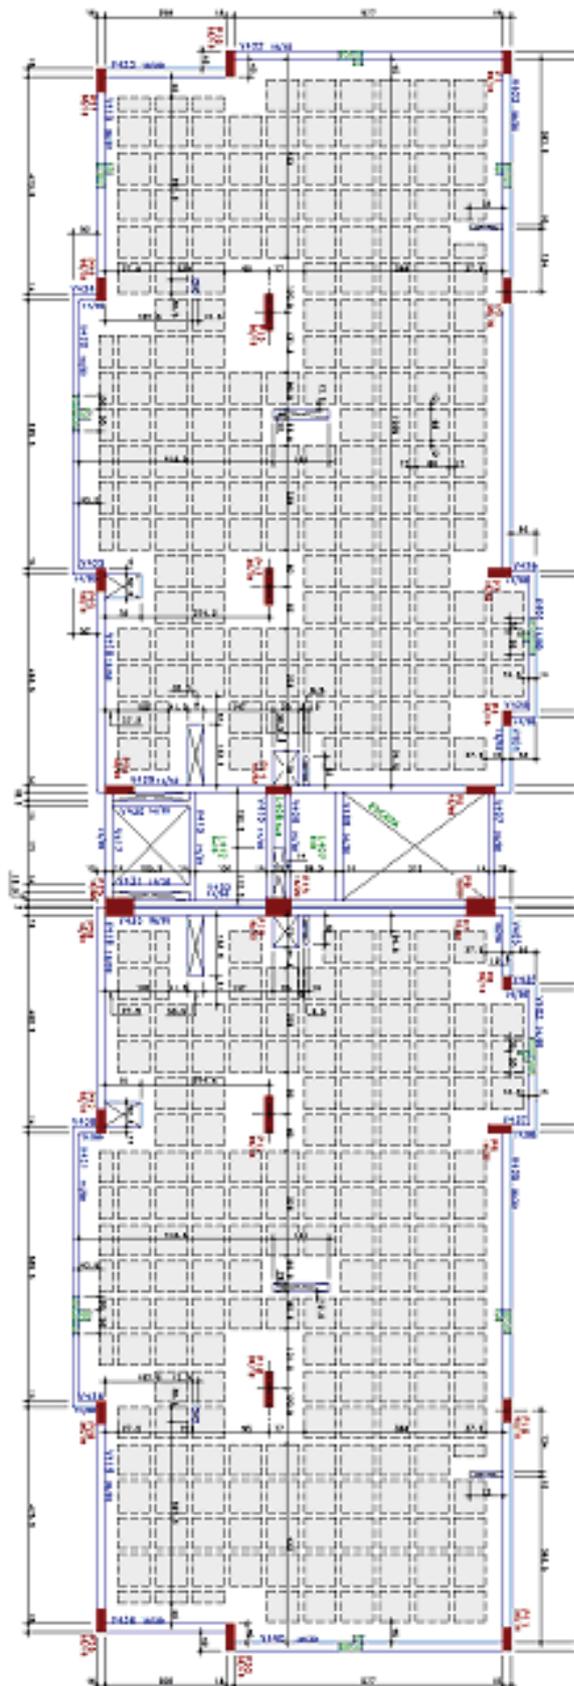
planta de fôrmas completa do pavimento tipo em laje nervada com blocos de EPS
